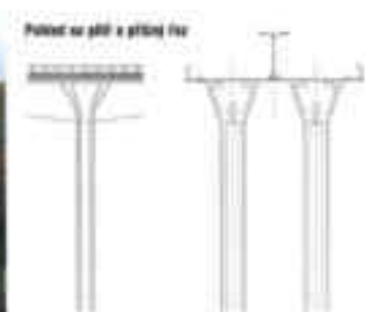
Letmo betonovaný betonový předpjatý most (provoz pěších v dolní úrovni)
